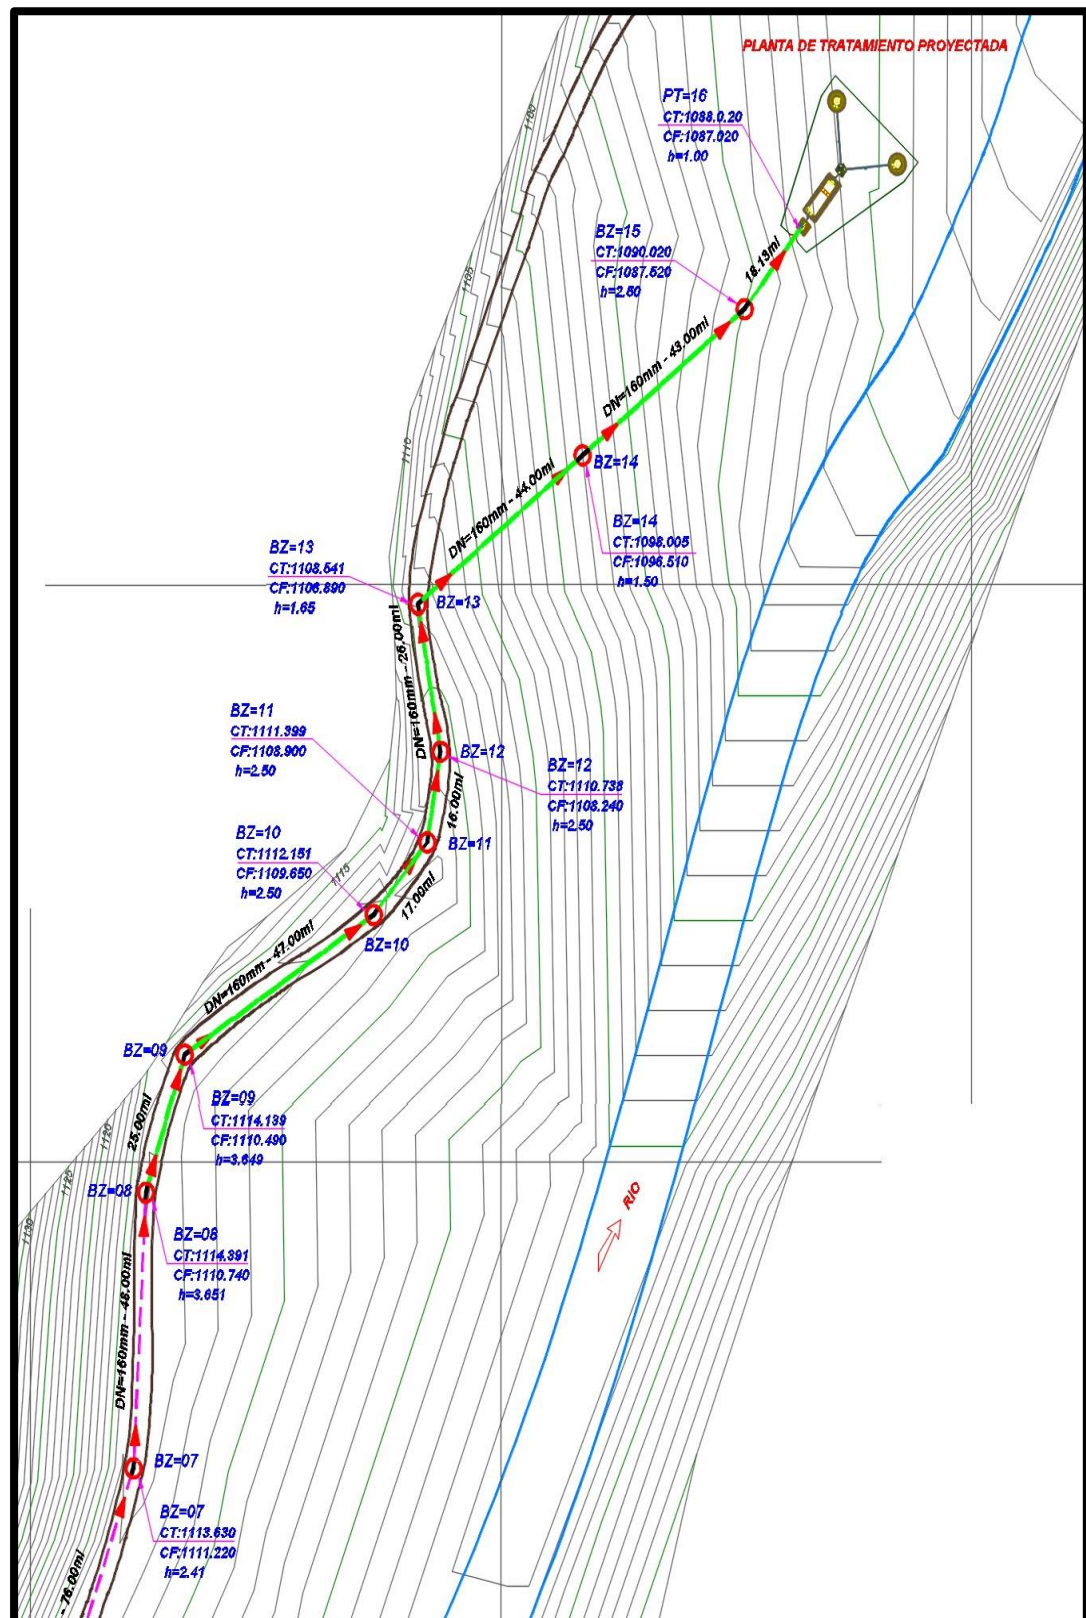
Diseño de planta de red de alcantarillado parte 2.
